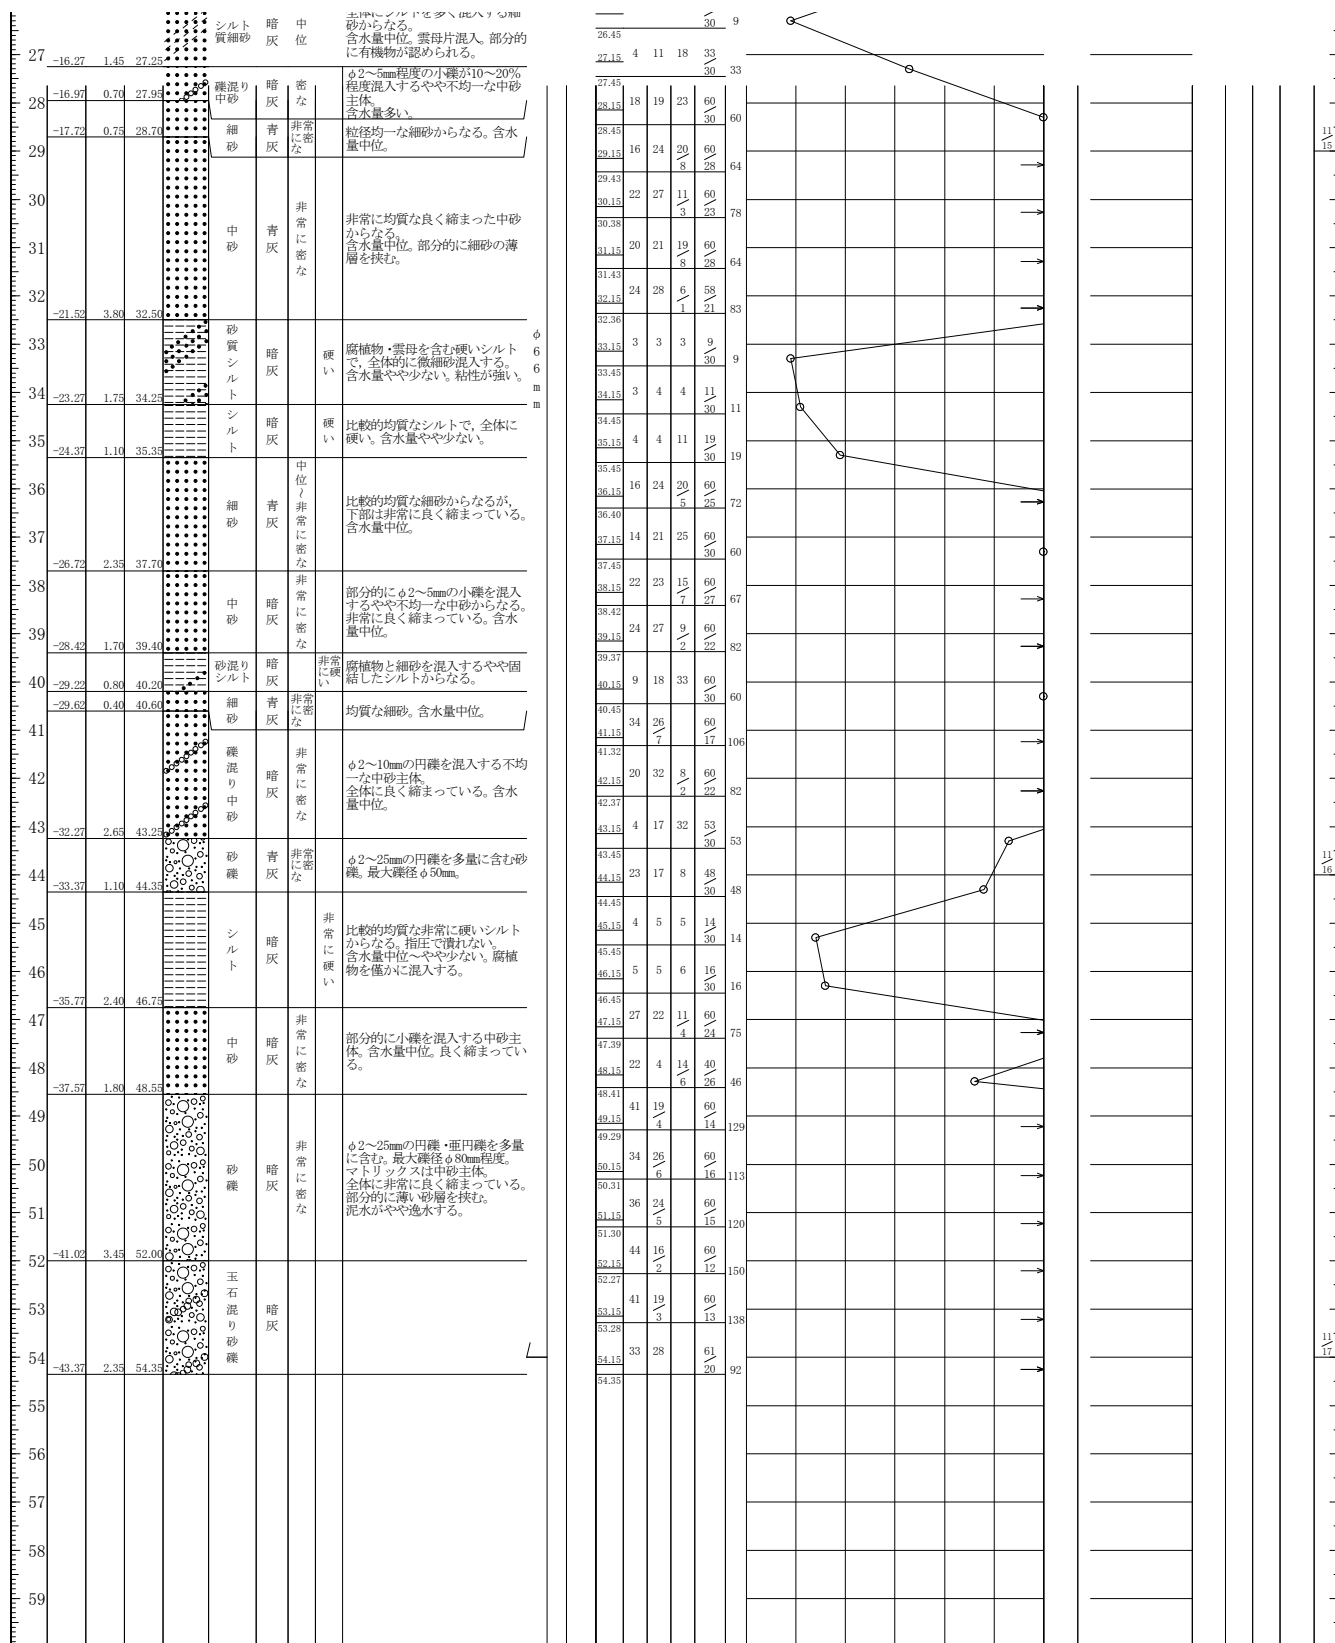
(1) ボーリング柱状図 (No.2-1)
